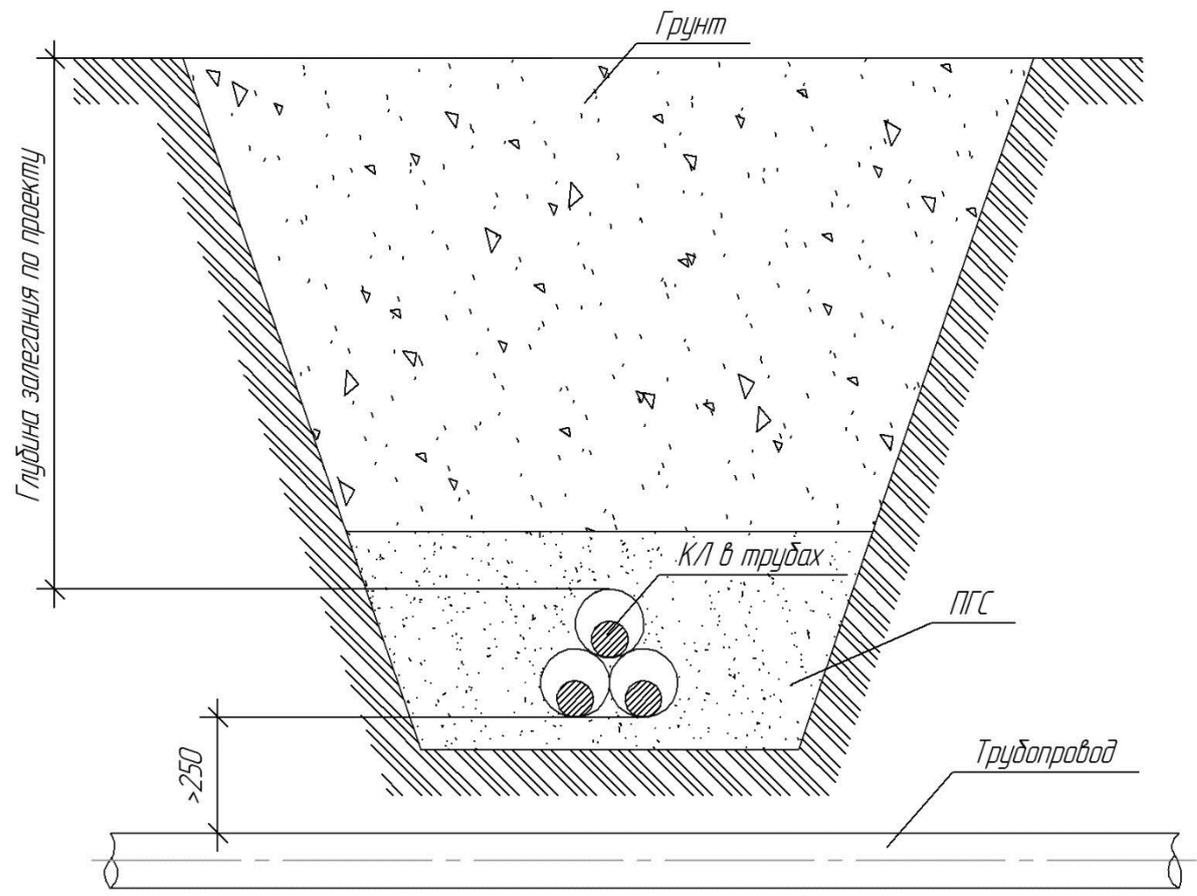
Пересечение КЛ с трубопроводом (КЛ сверху).
